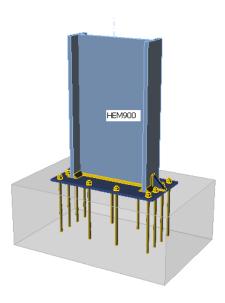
Vue en 3D de l'assemblage pied de poteau.
